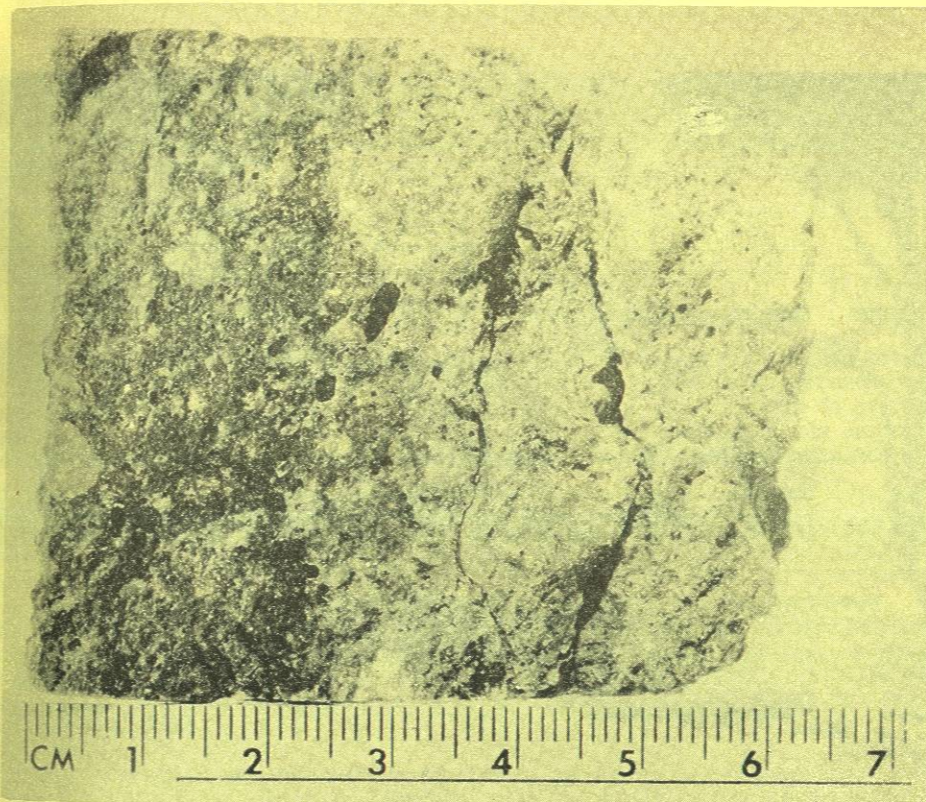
Sección transversal de núcleo tomado de una losa de puente impregnada superficialmente (las grietas ocurrieron cuando se tomó el espécimen). La zona impregnada con polímero aparece más oscura.
